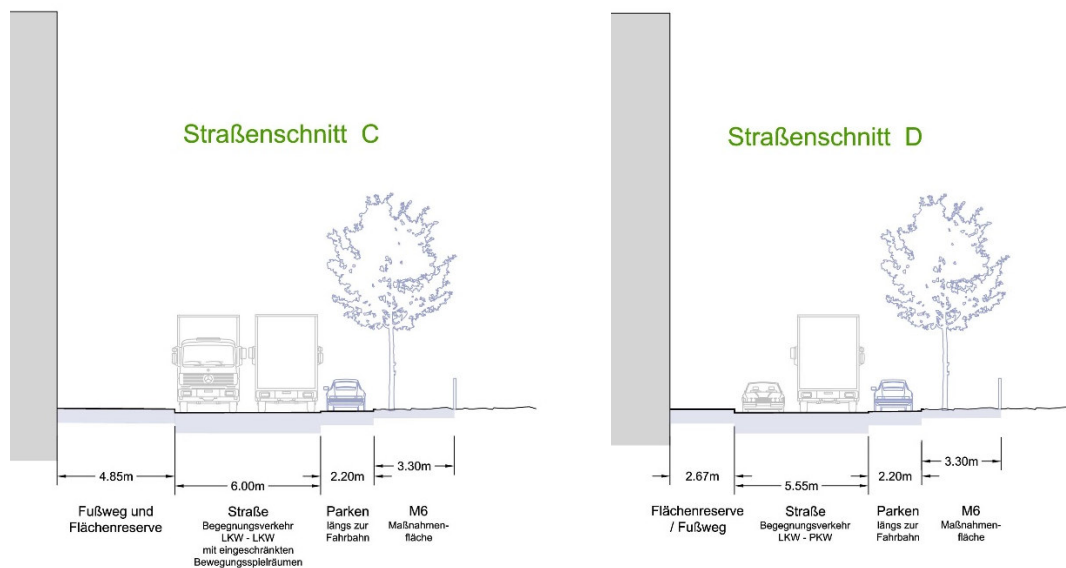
, 9: beispielhafter Schnitt der Erschließungsflächen im Plangebiet: Straßenschnitt C, D
